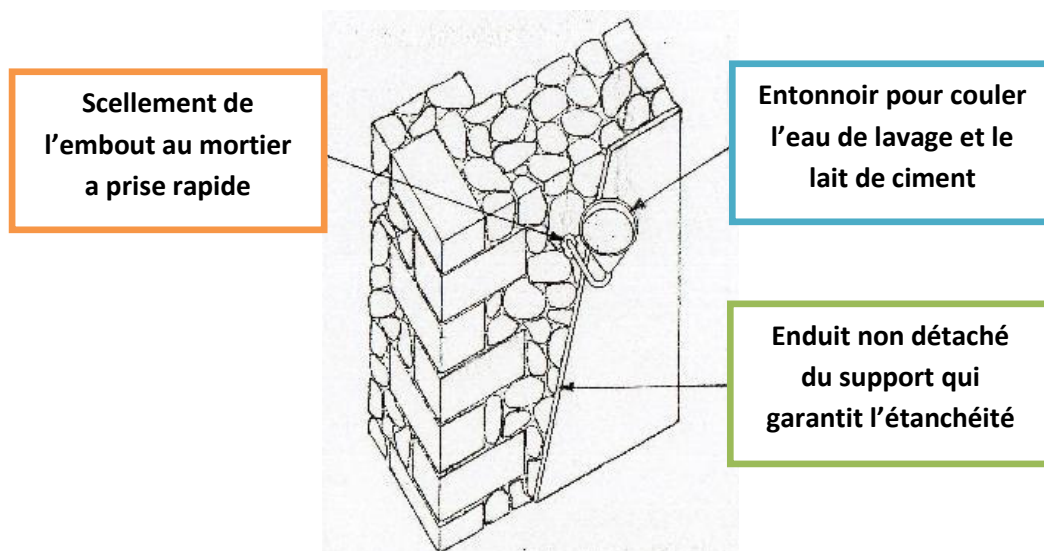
Cimentation d'un mur en pierre par coulée [50]
